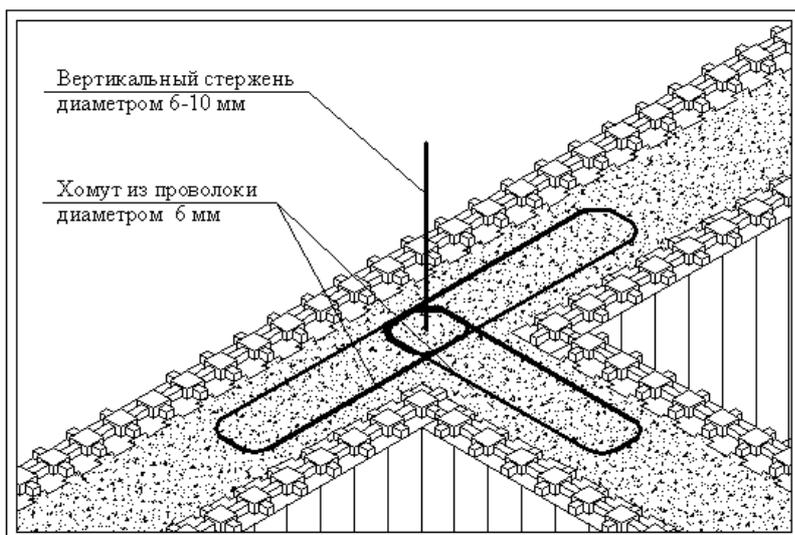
Конструкция угла стены из элементарных пустотелых блоков
